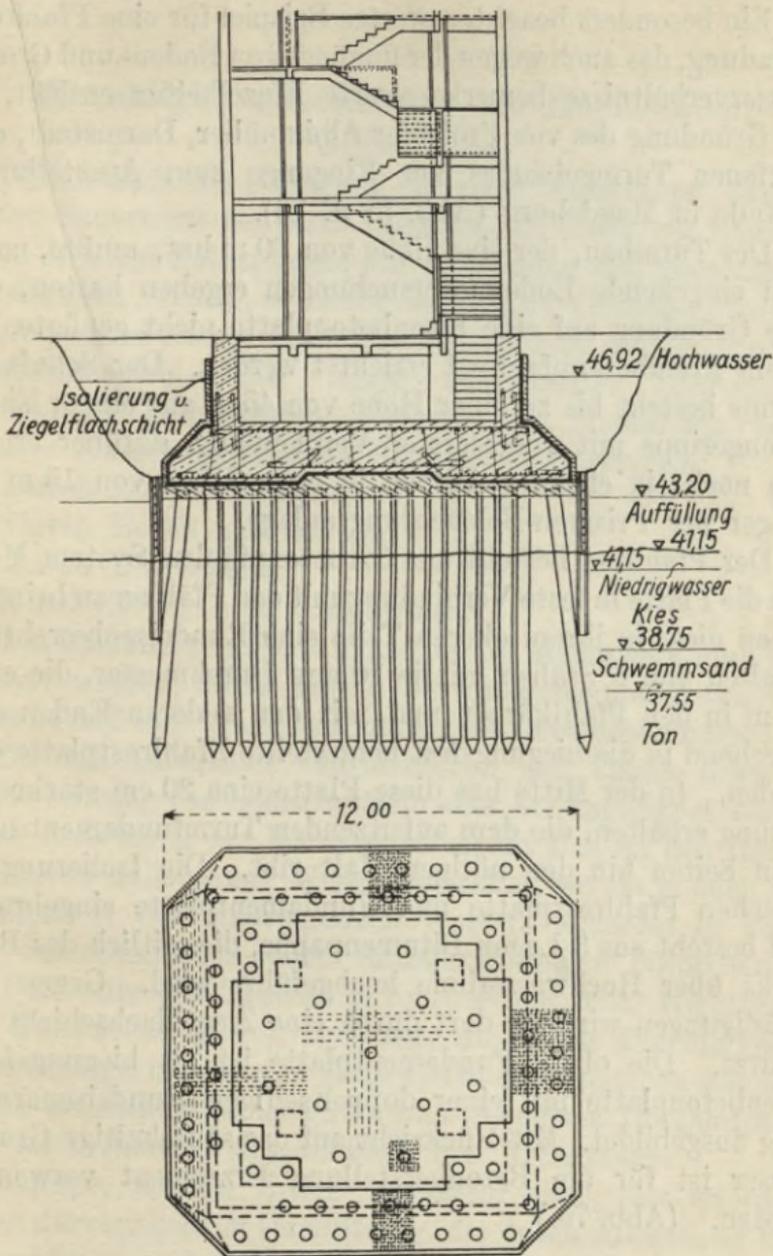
Fundierung des Ausstellungsturmes in Magdeburg (Grundriß und Schnitt). Arch. Prof. Albinmüller, Darmstadt. Ausf. Beton- und Monierbau A.-G., Berlin.
